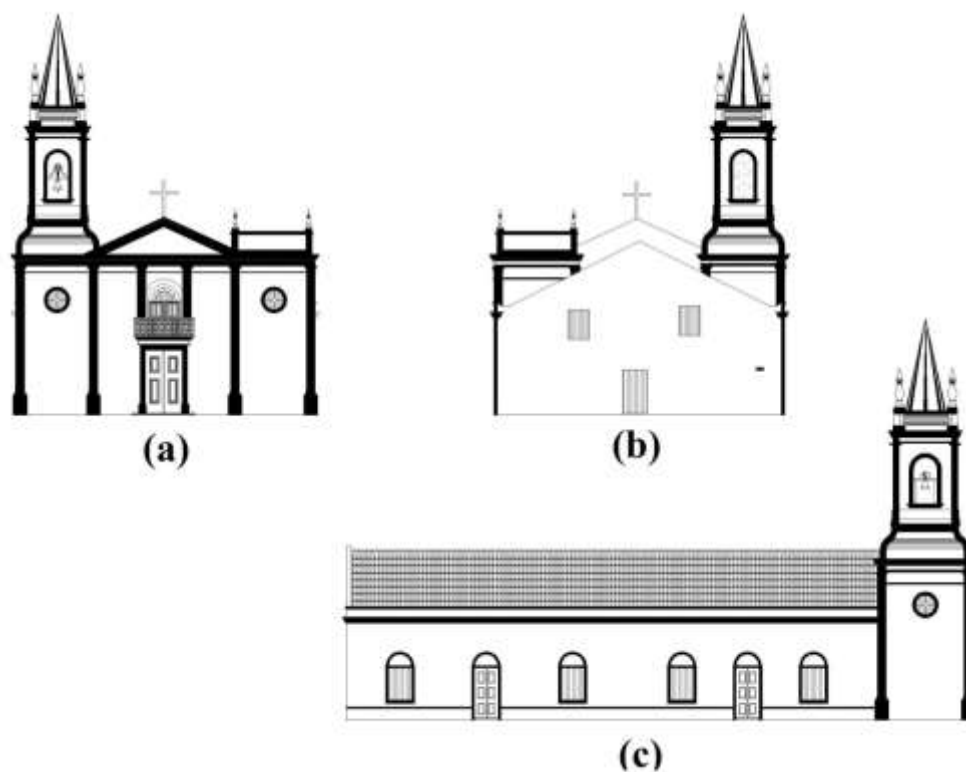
Cortes das fachadas analisadas da edificação: (a) fachada principal; (b) fachada fundo; (c) fachada esquerda.
